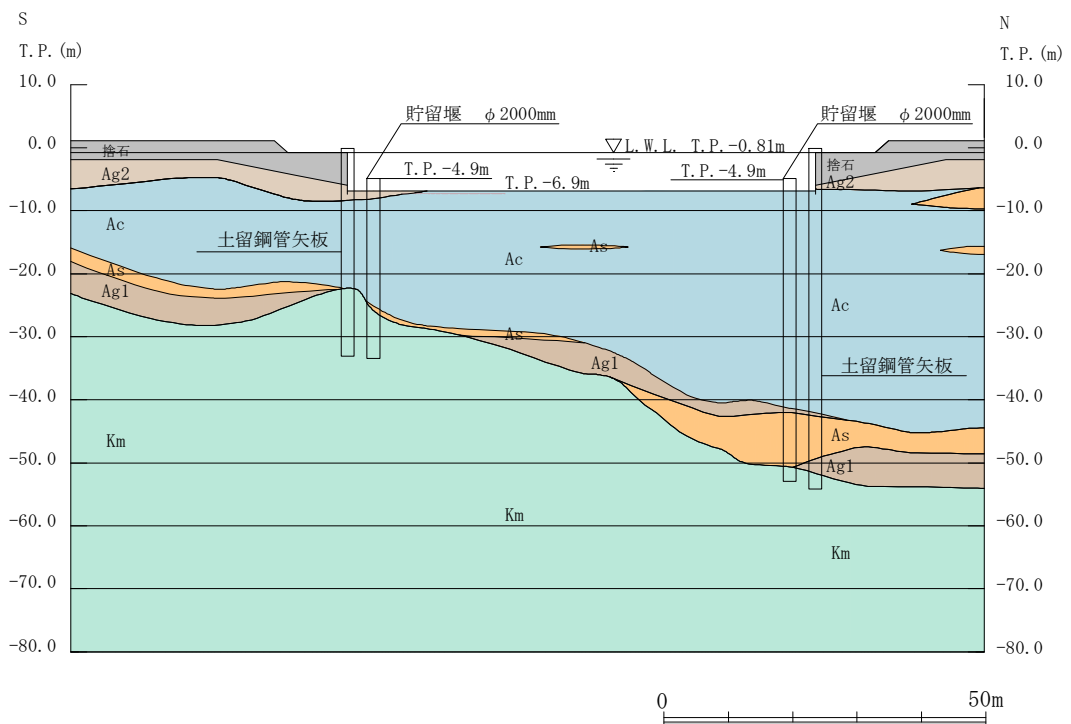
土留鋼管矢板の断面図 (NS-1)
